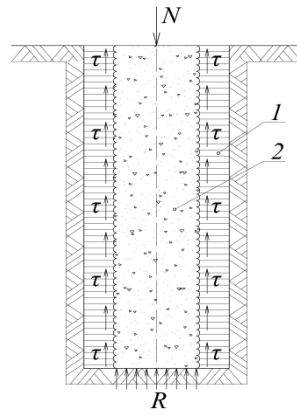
Схема к определению несущей способности сваи SFA (НПШ) по грунтоцементному основанию  $F_{d1}$  1 – грунтоцементный массив, 2 – свая SFA (НПШ)
